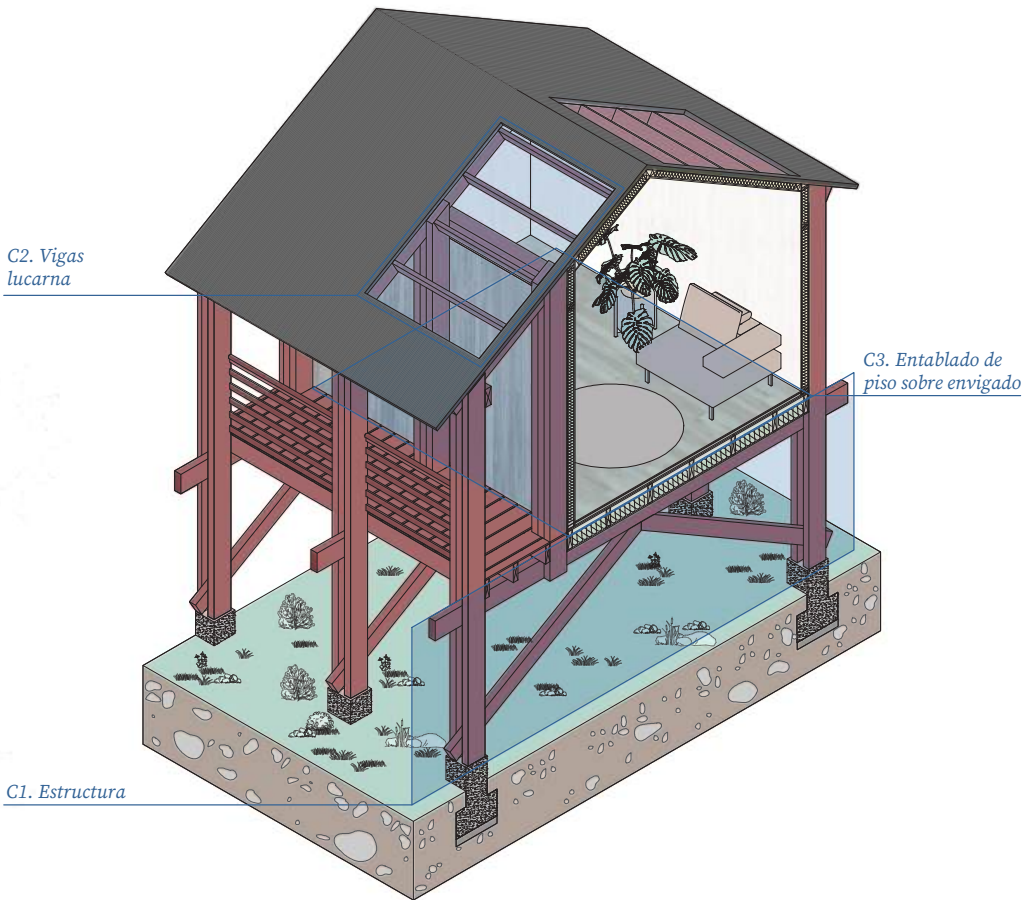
Caso de aplicación C - Edificación poste y viga
